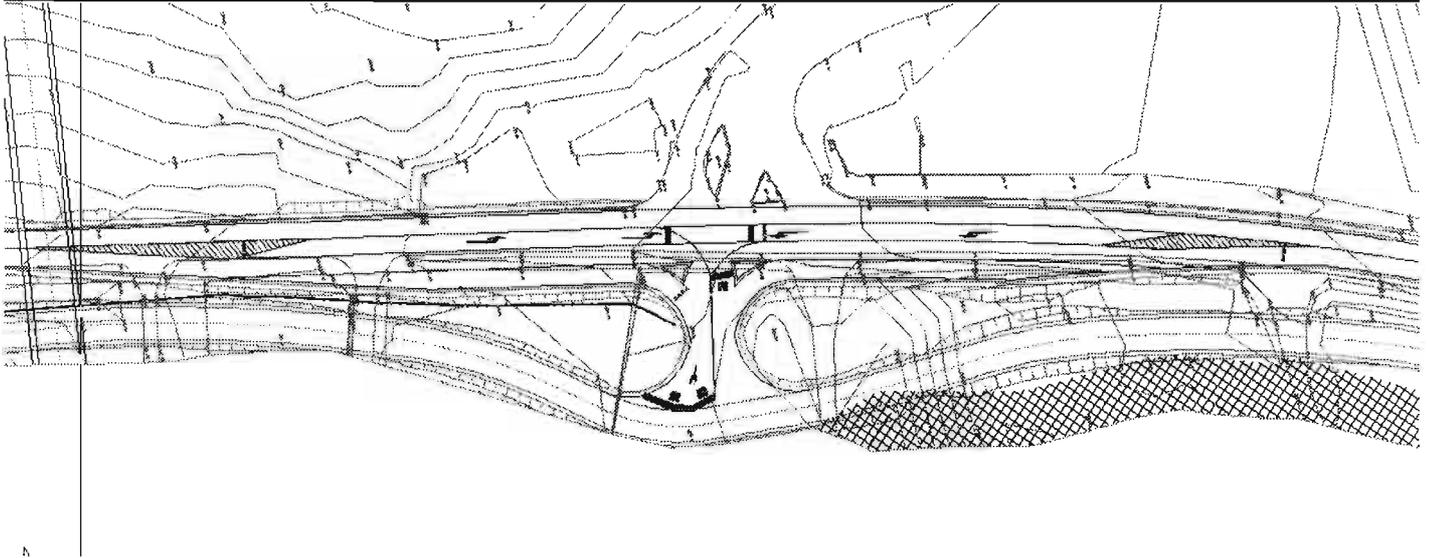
Schema planimetrico accesso cantierizzazione Forch
